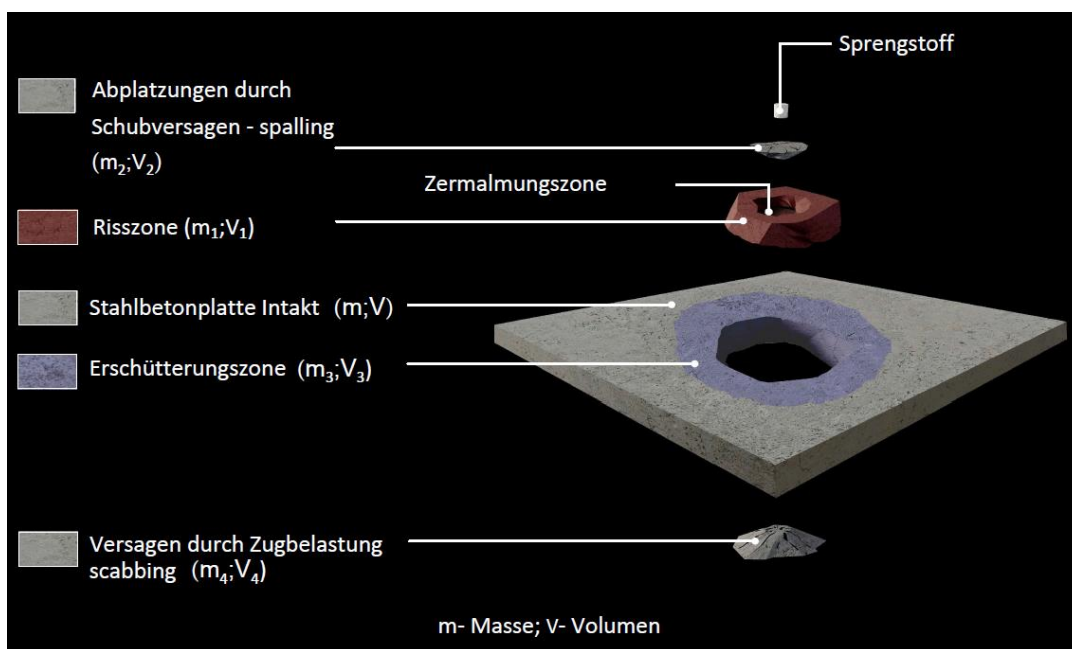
Stahlbetonplatten nach Kontaktdetonation. Schädigungszonen mit entsprechenden Massen und Volumina.
